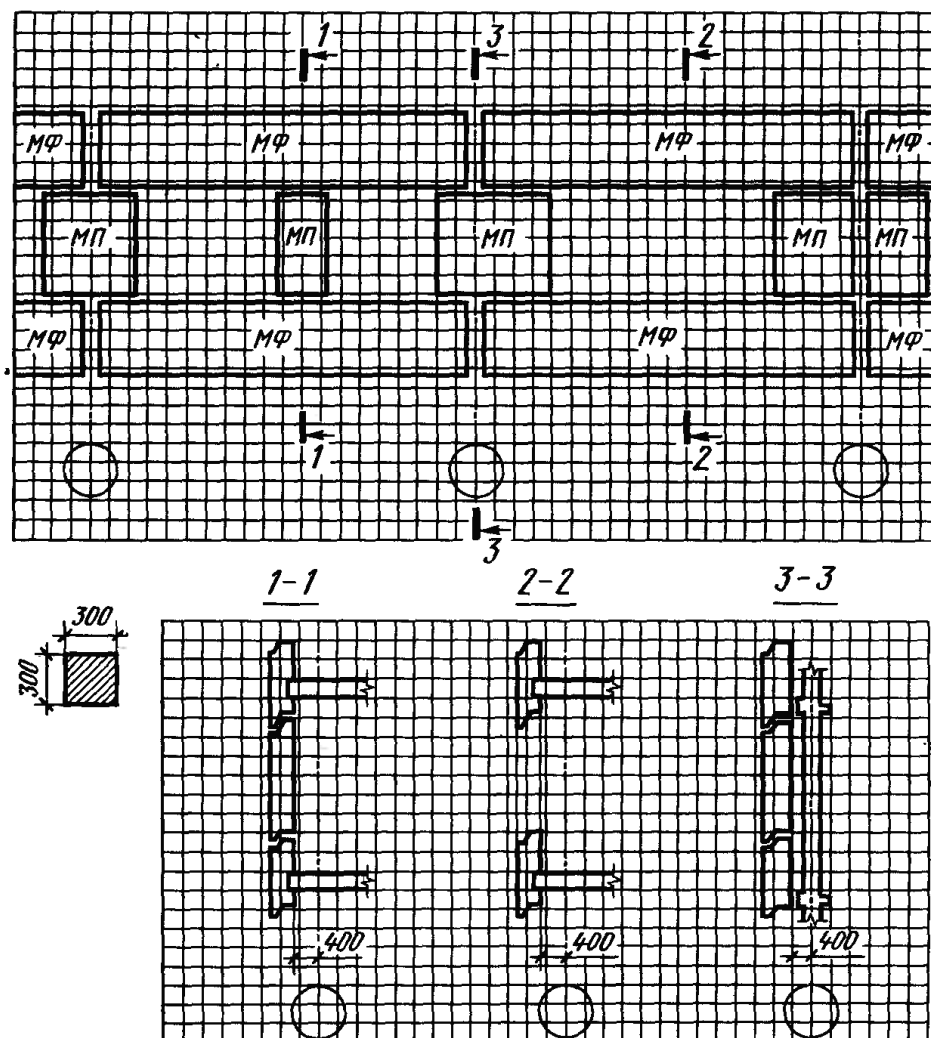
Фрагмент фасада каркасно-панельного здания. МФ — фасадная стеновая панель, МП - простеночная стеновая панель
